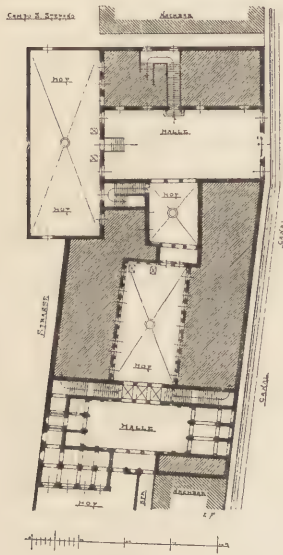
Palazzo Pisani zu Venedig. Grundriss.
